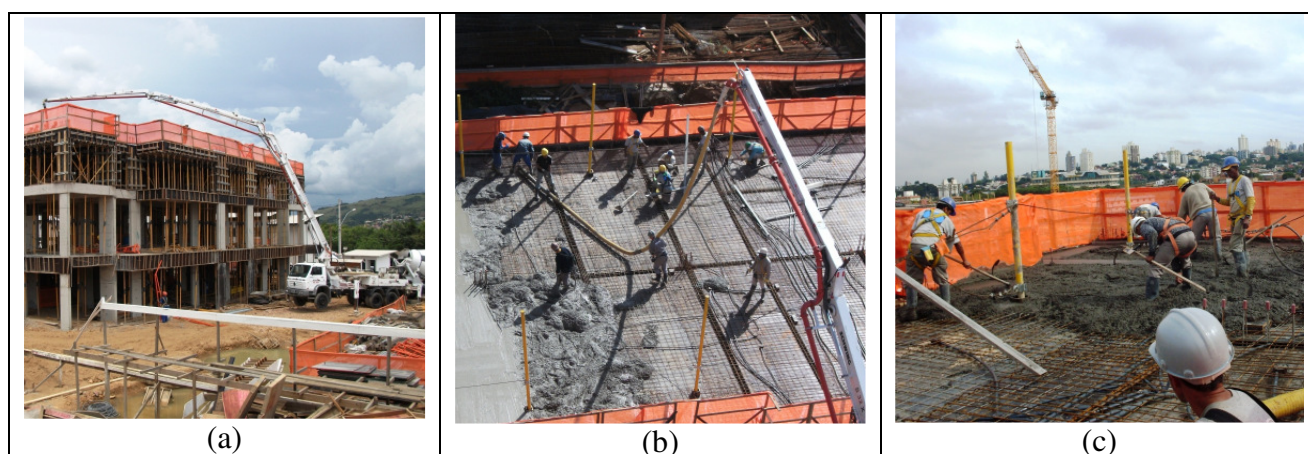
fotos ilustrativas da concretagem das vigas e lajes
